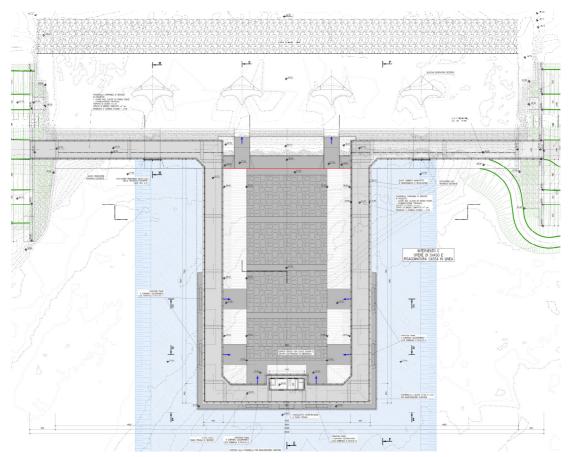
Adeguamento manufatto di regolazione in linea - Pianta
